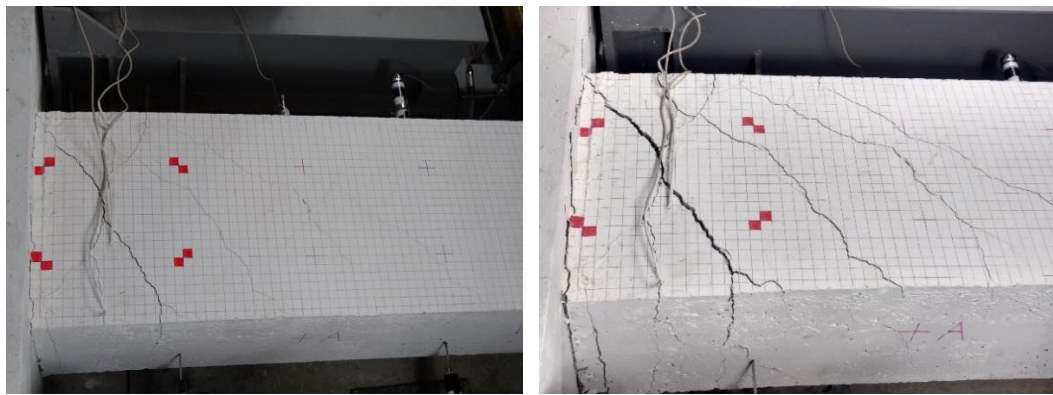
Ensanchamiento de grietas e inicio de desconchamiento en el paño de la columna ($E - 1$).
